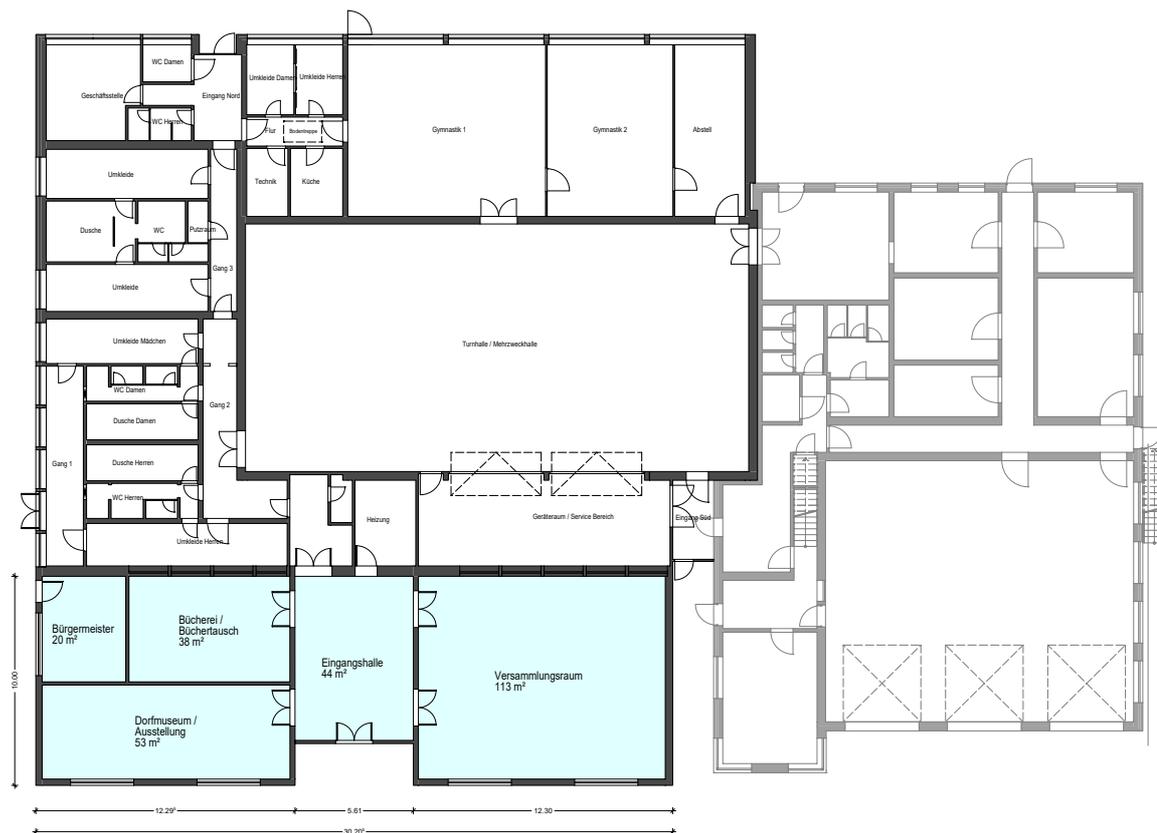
Grundriss Anbau Dorfgemeinschaftshaus an der alten Turnhalle (ohne Maßstab)
